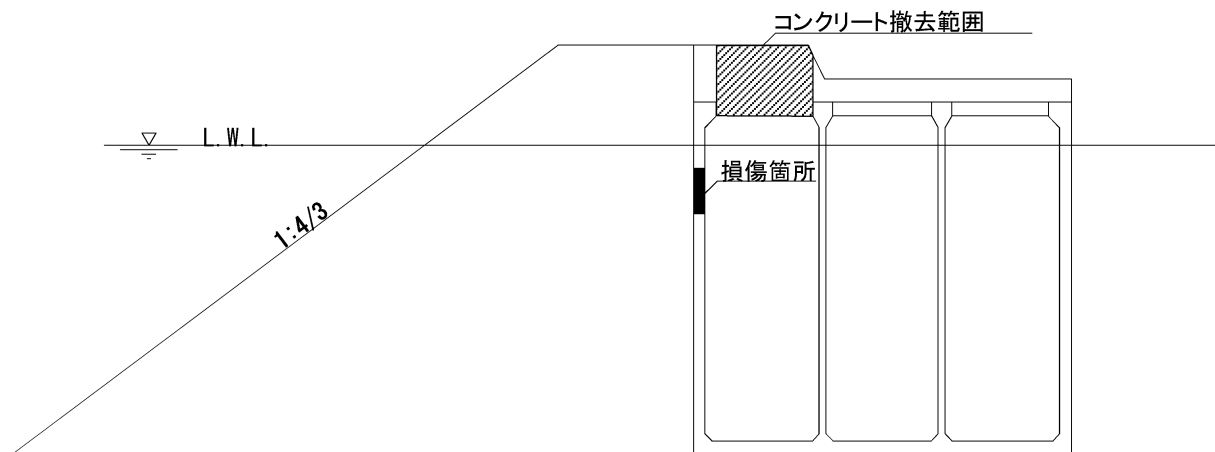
被災後補修ケース B の上部コンクリート撤去範囲（断面図）
